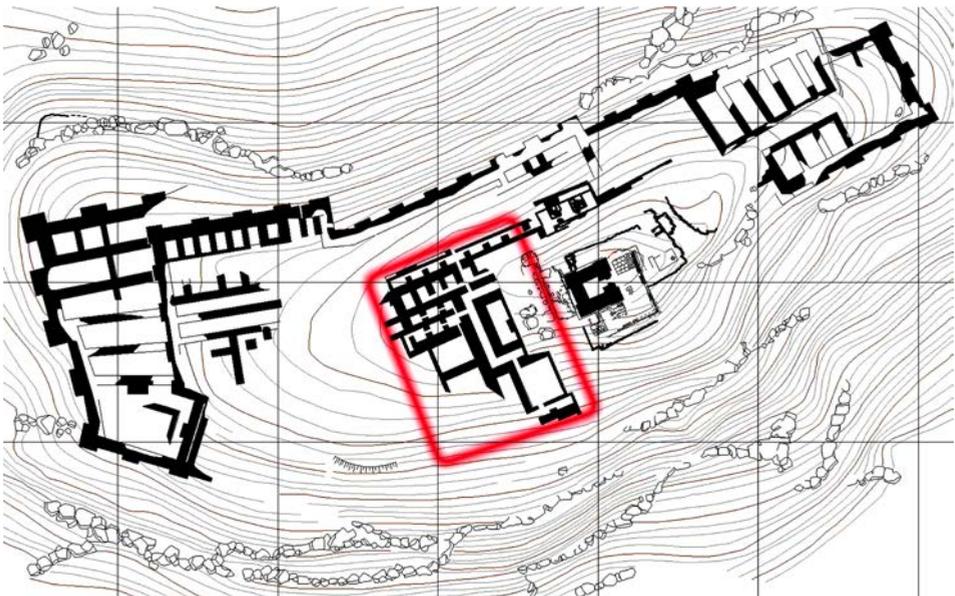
Le plan de la forteresse d'Arguichtihinili, Armavir
